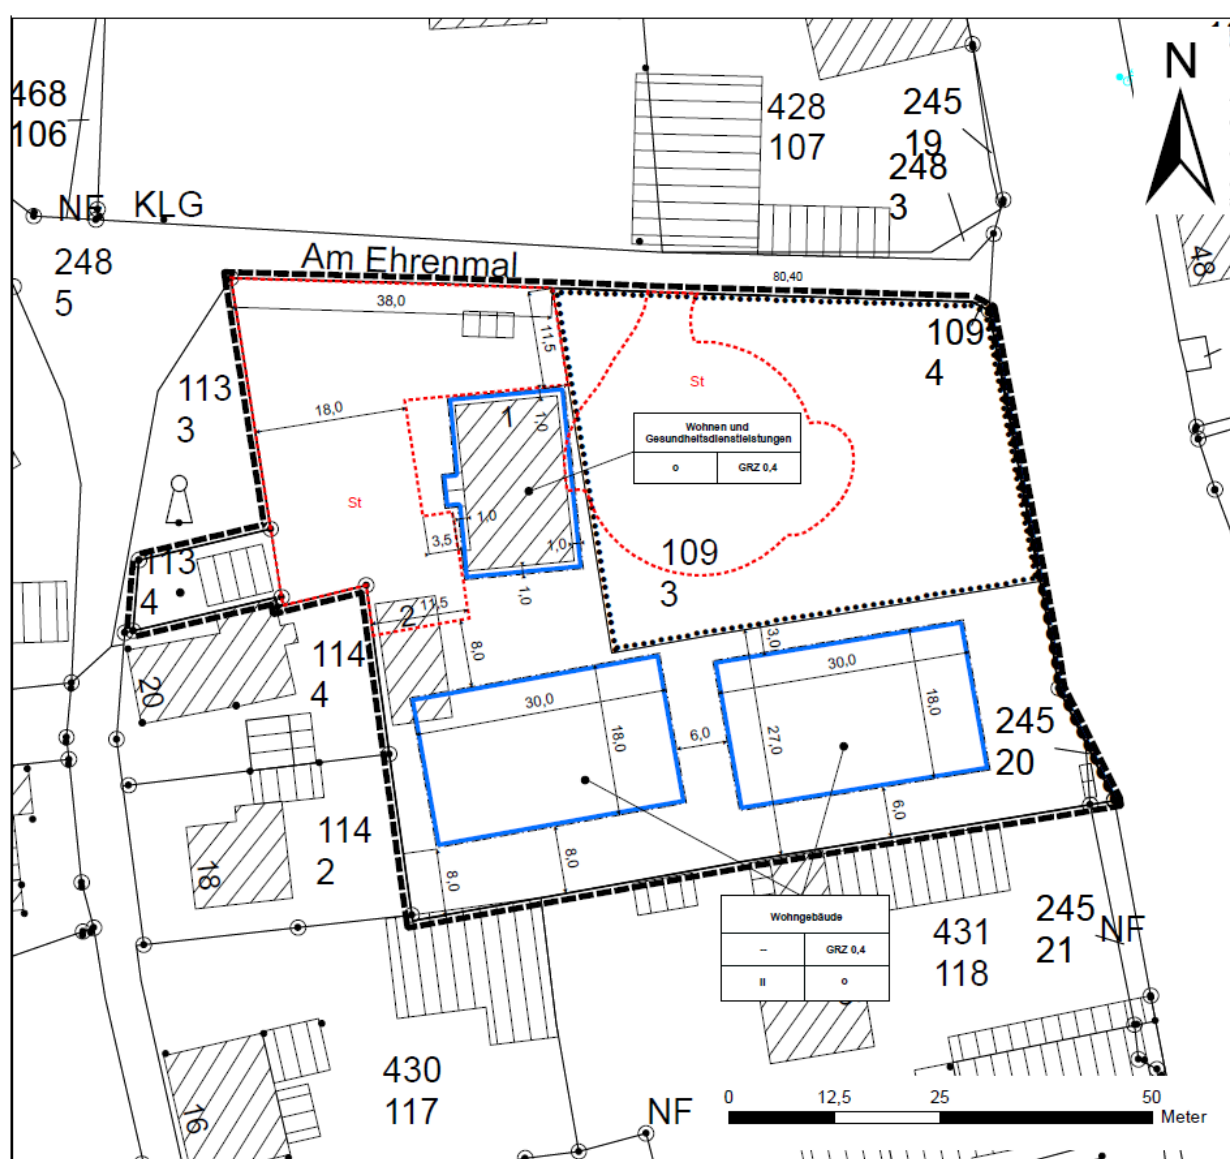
Ausschnitt aus dem Entwurf zum Bebauungsplan (Quelle: Planungsgemeinschaft Nord GmbH, Große Straße 49, 27356 Rotenburg (Wümme) Planstand 11.08.2023)
